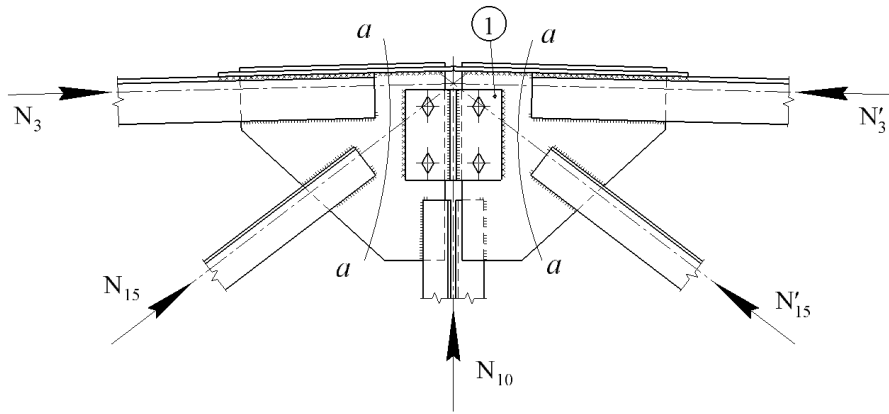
Вариант монтажного стыка марок верхнего пояса фермы
